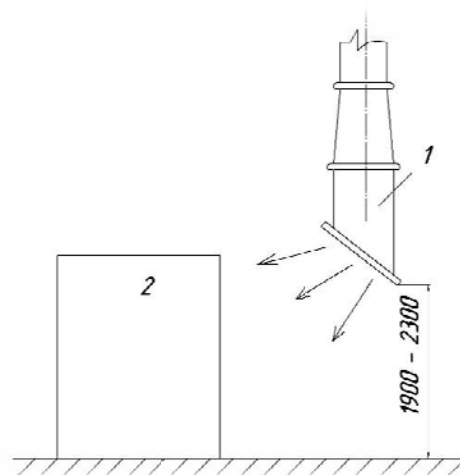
Установка душирующего патрубка: 1 – душирующий патрубок; 2 – нагревательная печь
